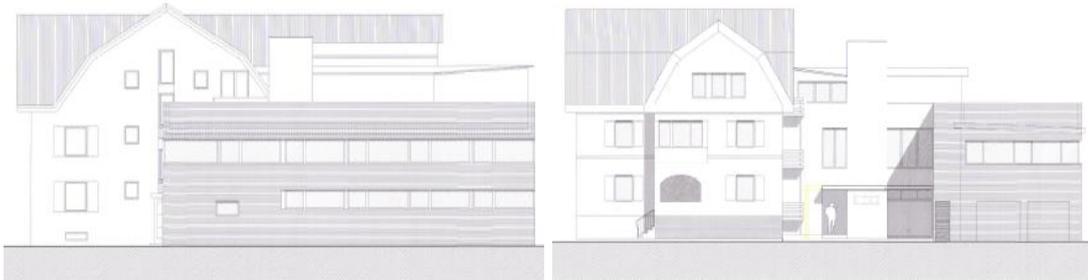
Fassadenerneuerung des Geschäftstraktes nord -(links) + ostseitig (rechts); Planausschnitt Baueingabe Zubau Fluchtstiege – Fassade Nordzubau Planstand 03.11.2003 (eigene Aufnahmen)
